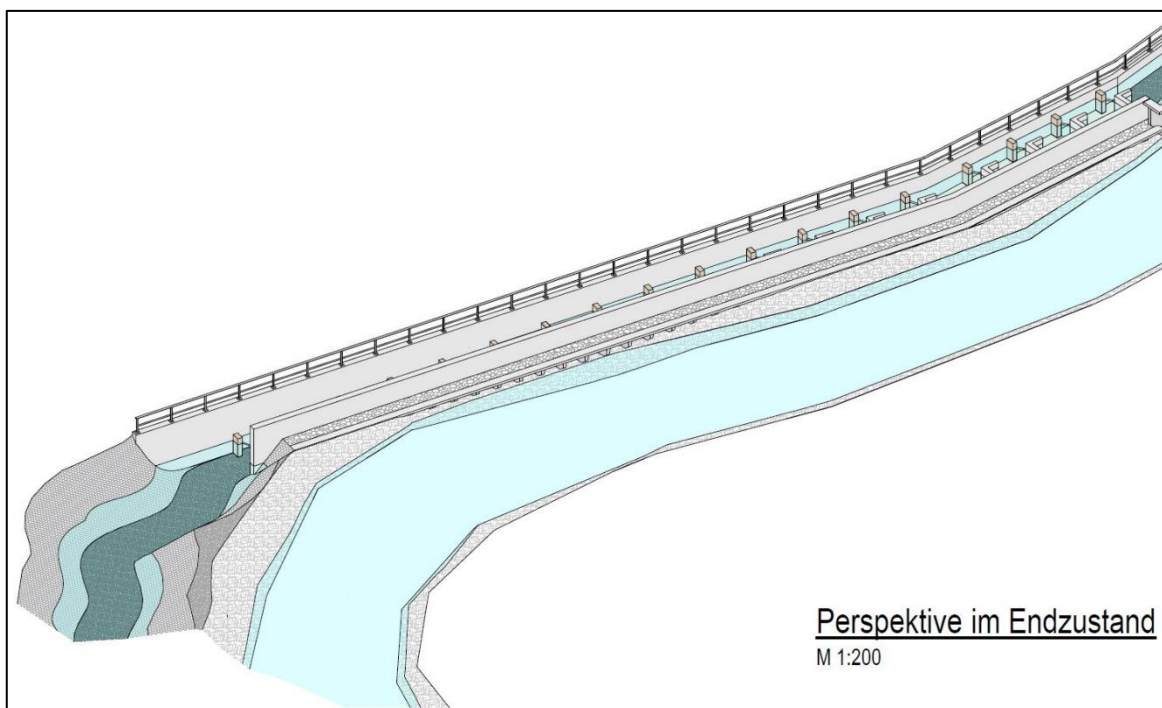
Isometrie Mittelbauwerk – Schlitzpass mit Längesmühlbach
